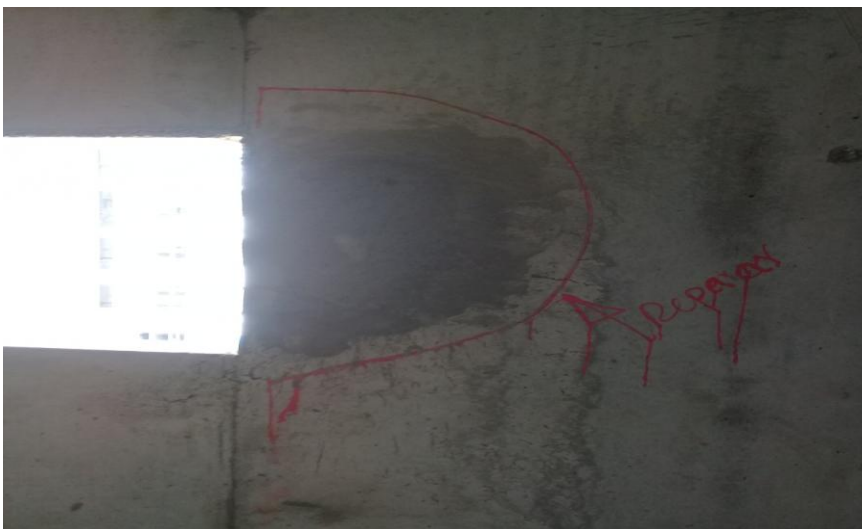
Muro 30- losa de entrepiso. Fuente: autor.
